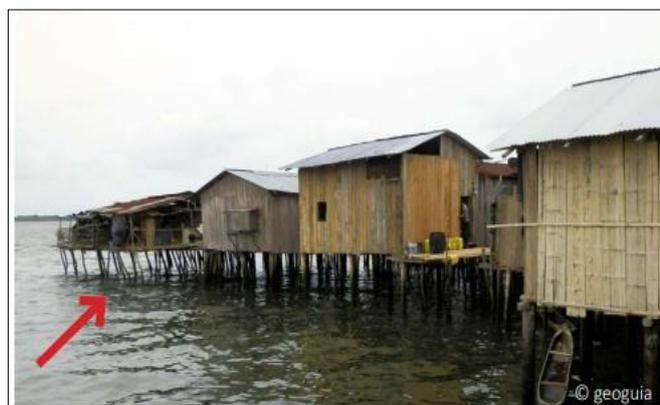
Estructura vertical sin arriostamiento genera falta de equilibrio
